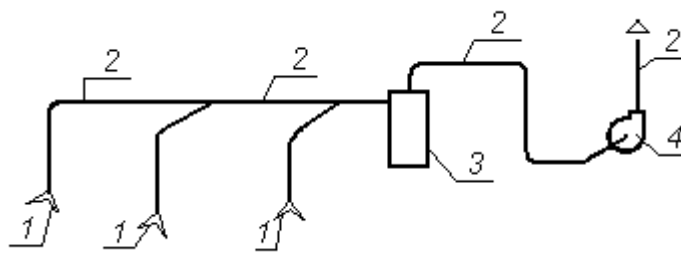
Схема местной вытяжной системы вентиляции:
